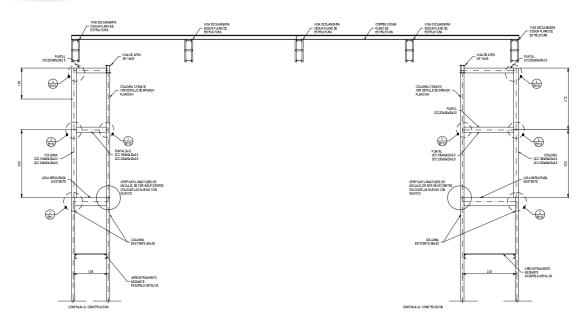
Vista de Refuerzos de Arriostramientos de Columnas de apoyo de cubierta.
